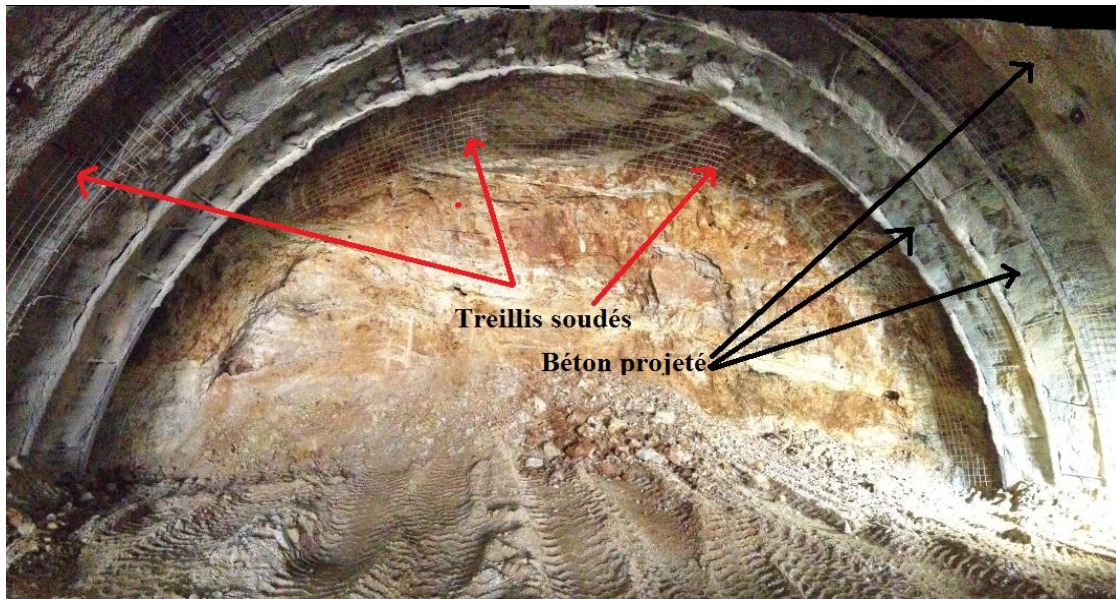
Photo de treillis soudés et du béton projeté utilisés au tunnel d'Ait Yahia Moussa (Avril-2017).
